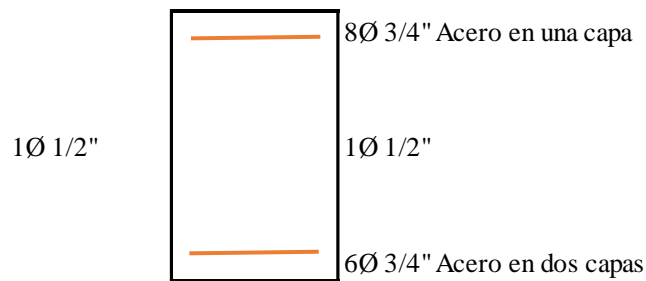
Distribución del Acero longitudinal de VP-102 (40x90) - Sistema estructural tradicional.
